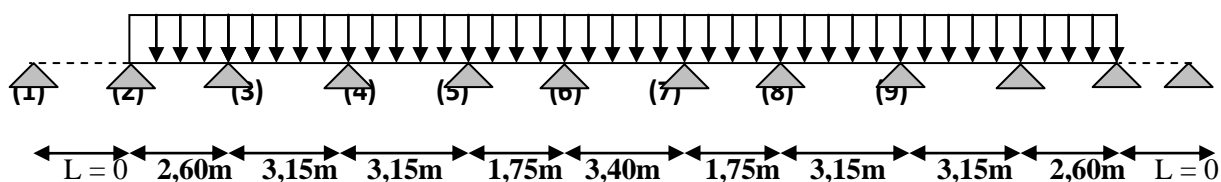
Schéma statique de la poutrelle :
